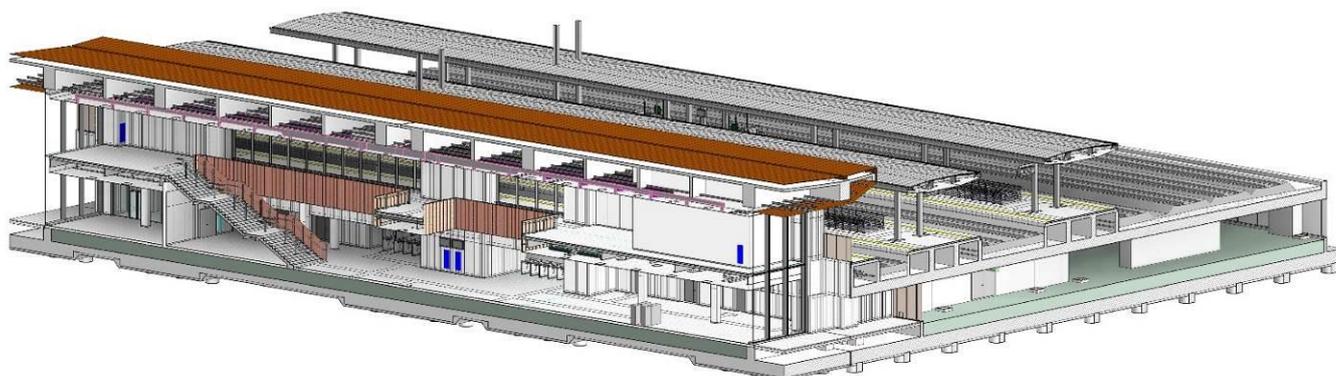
Spaccato assometrico coordinamento impianti stazione
